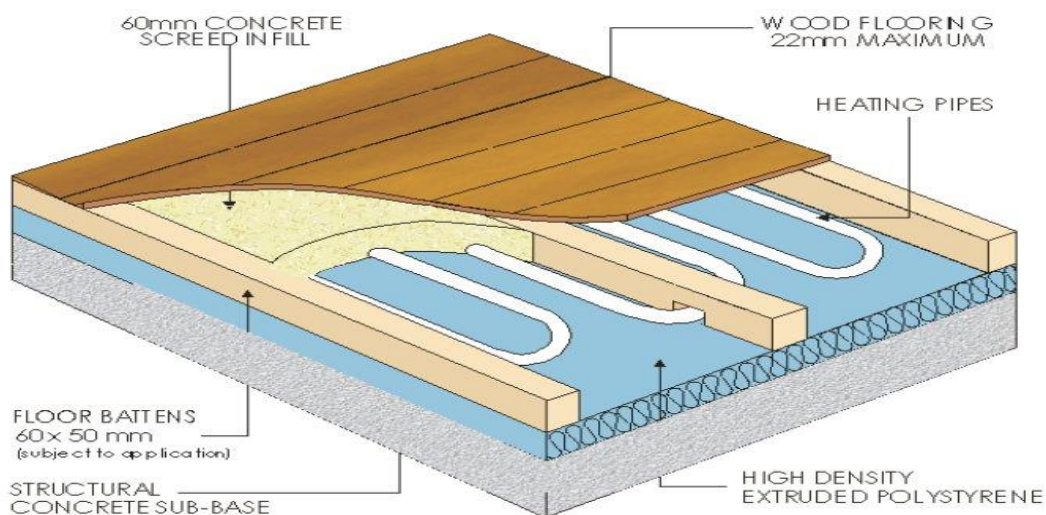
Estrutura típica de um piso radiante hidráulico (Borders Underfloor Heating Ltd 2009).
